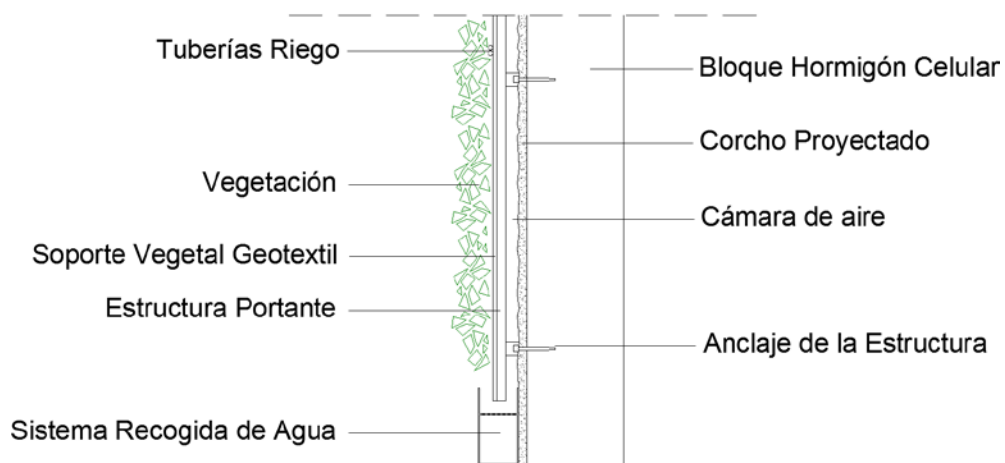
Detalle Fachada Vegetal. 2017. Propio
